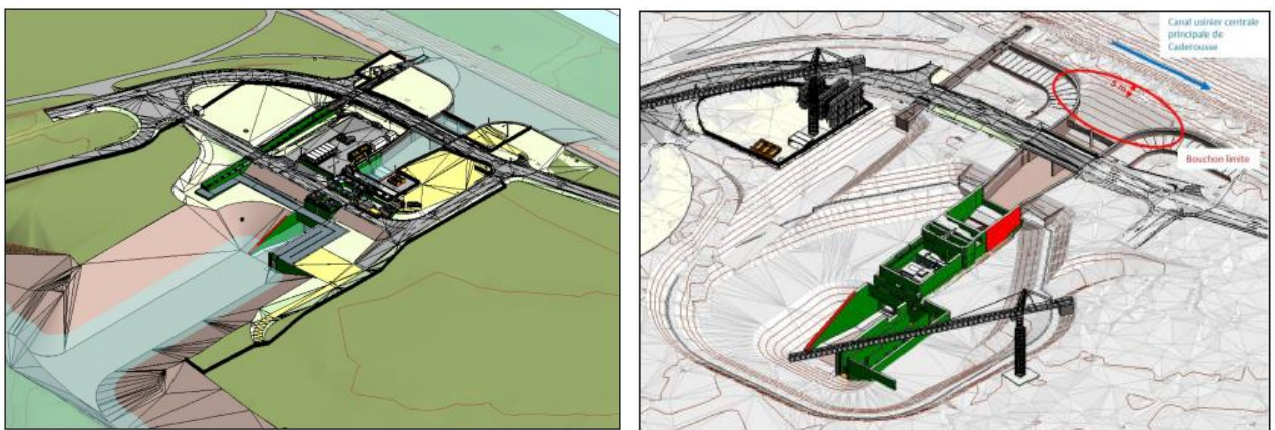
plans 3D des terrassements prévus pour construire la PCH et la PàP (source : dossier)
